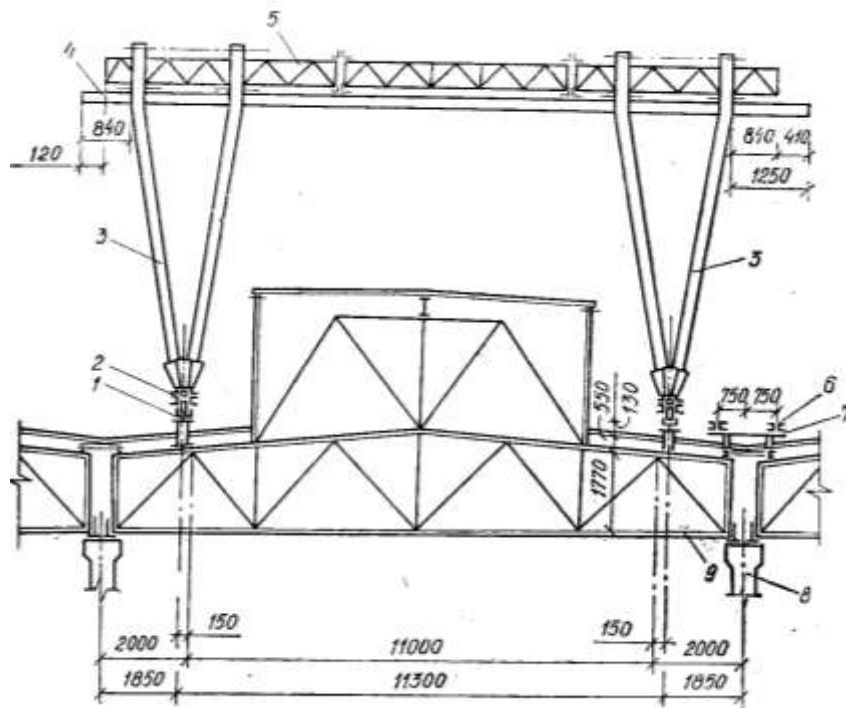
Покрівельний кран ВО «Харківрембудмонтаж»:
